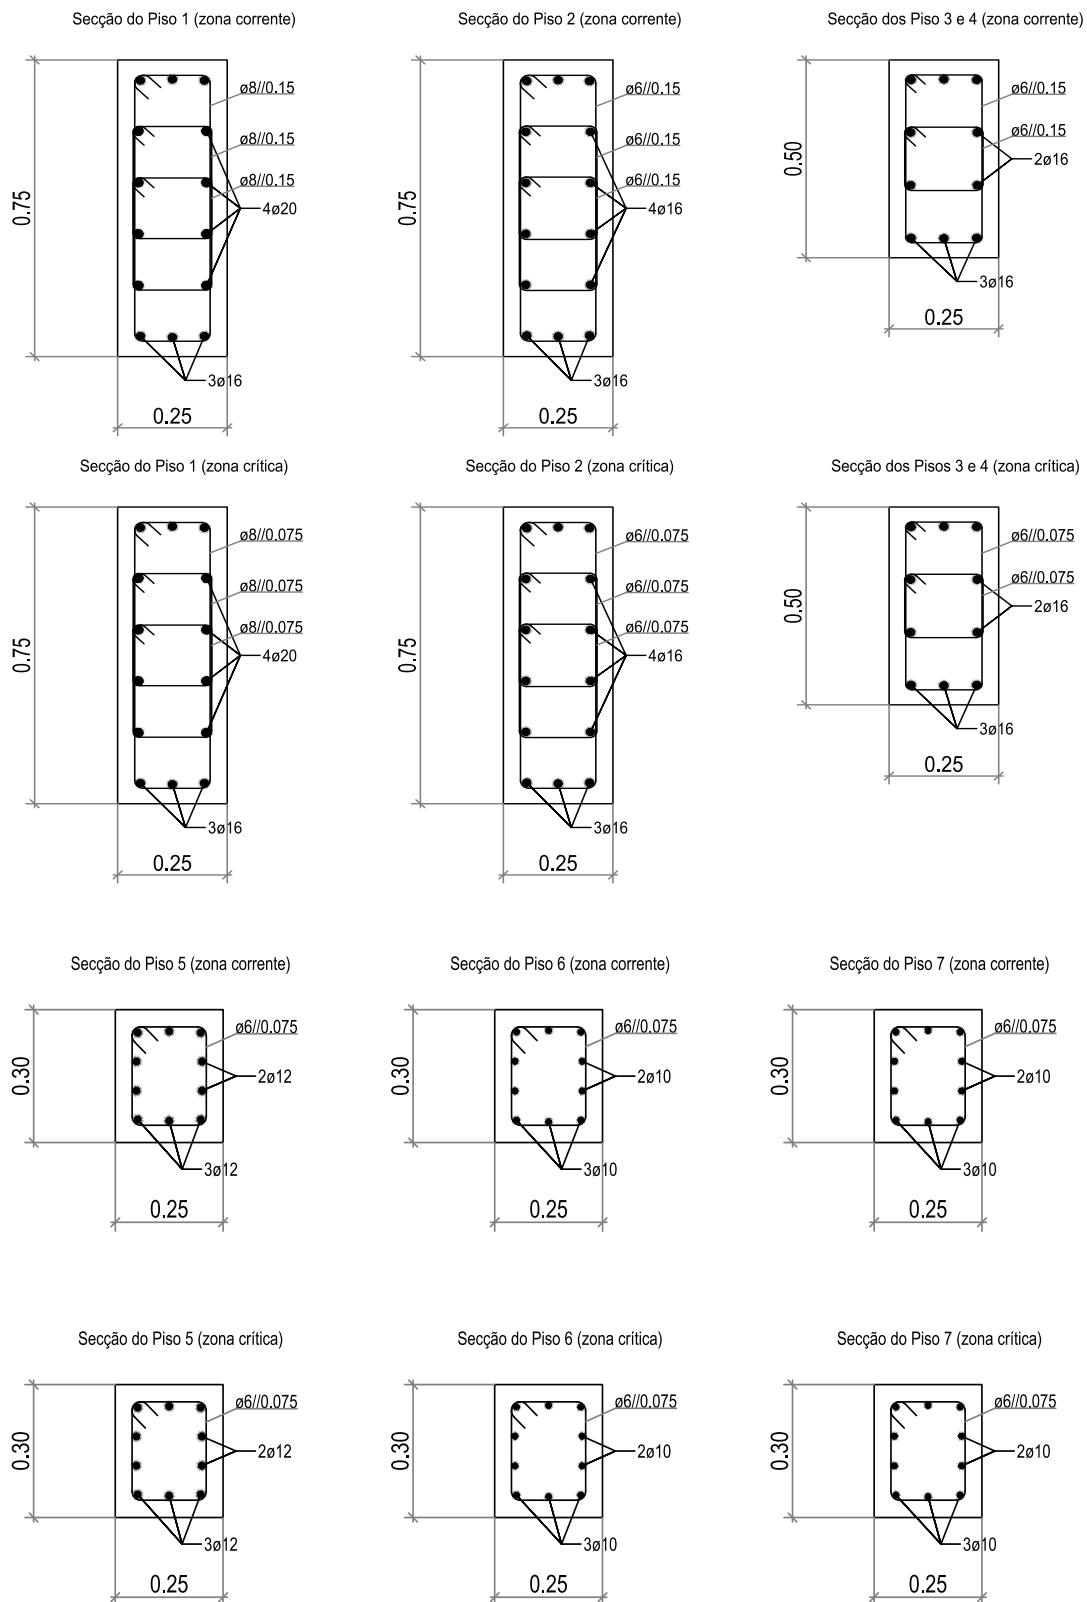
Edifício Real: Secções de armadura do pilar central (P3)
